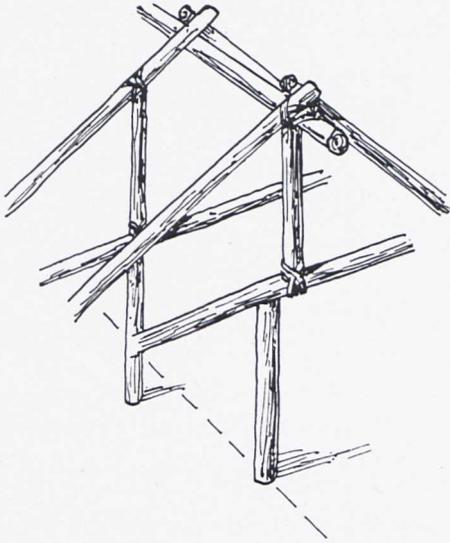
Firssäulen. Angeblicher Dachaufbau beim sogen. „Vandalenhaus“.
